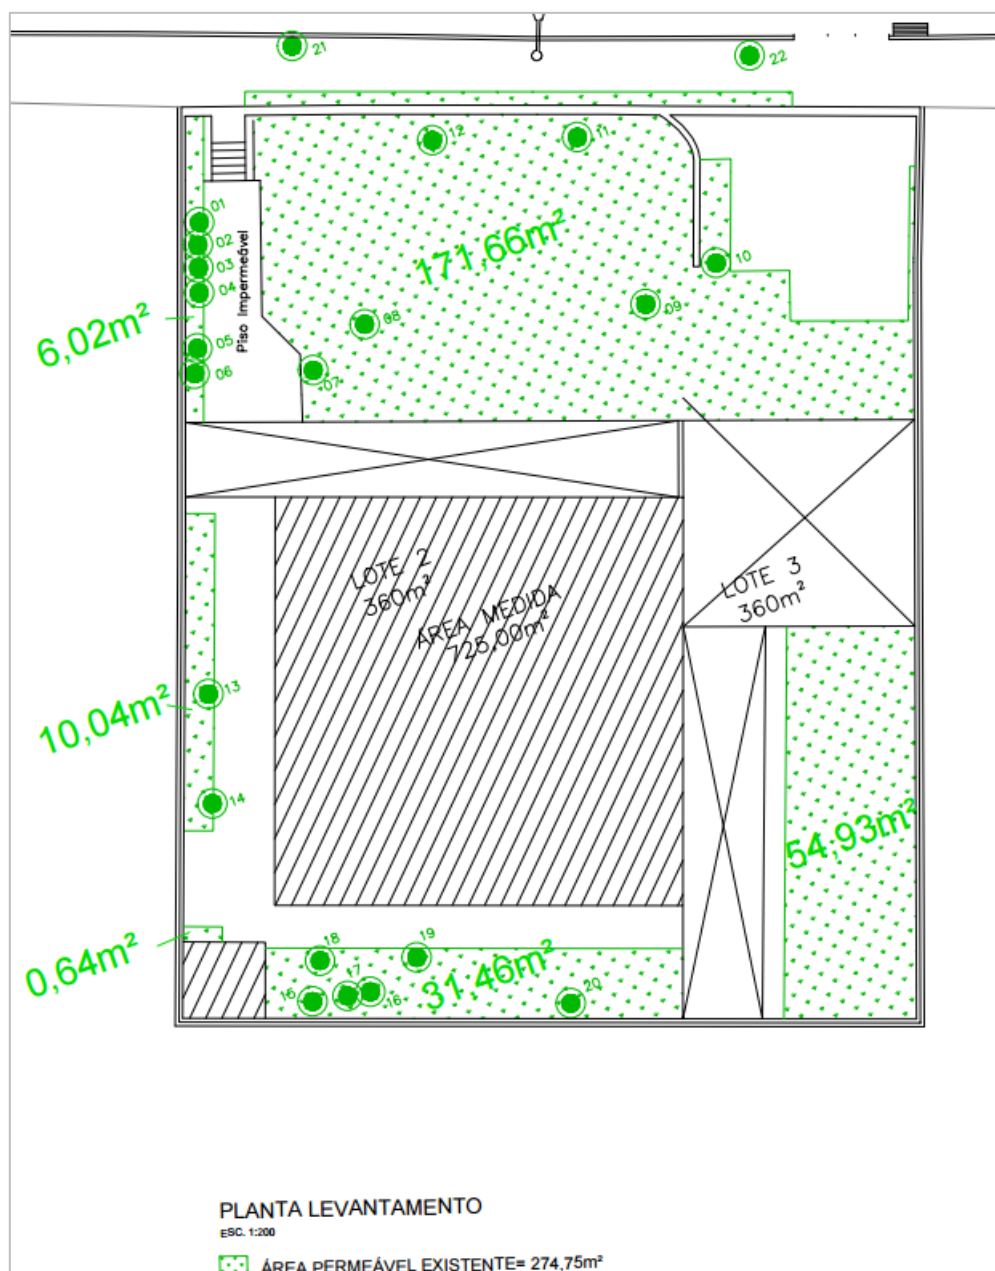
Recorte da planta de memória de cálculo indicando as áreas permeáveis existentes.
